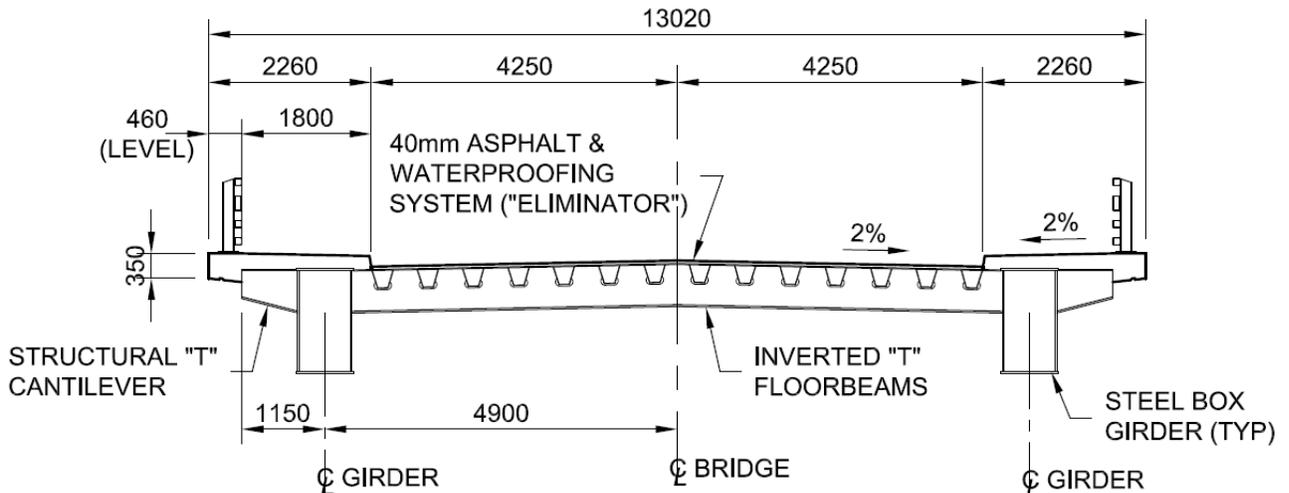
Coupe transversale de la travée levante – option tablier orthotrope en acier
